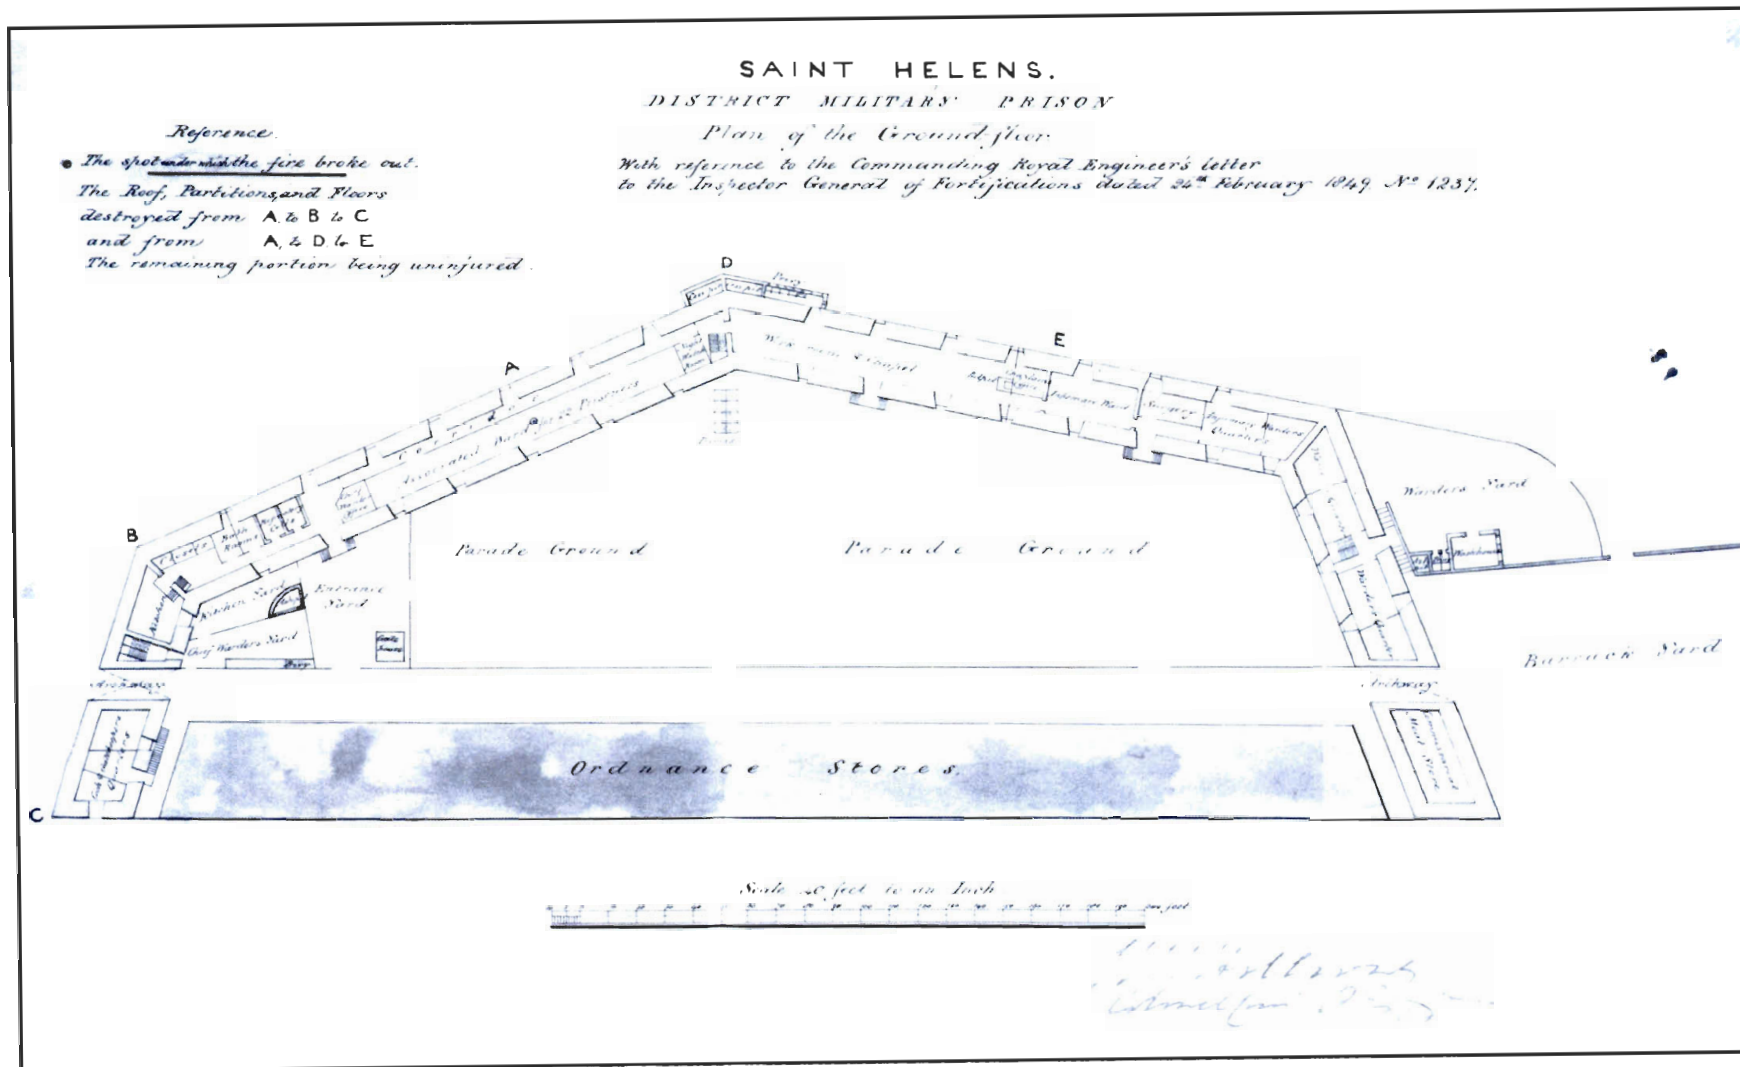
William Holloway, « Plan of the Ground floor », 1849 (PRO, WO44/591, f. 365)
